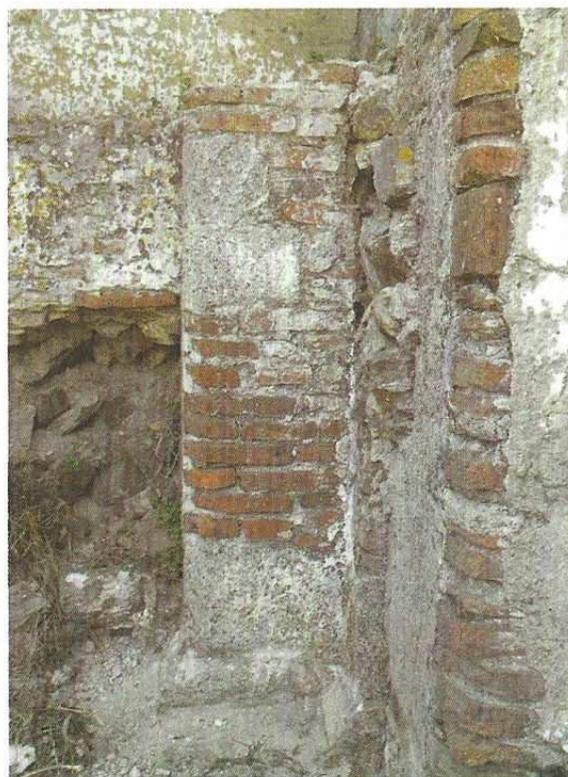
Pilar direito. Foi bastante destruído pela campanha de obras do século XVII, embora facilite um exame mais detalhado dos materiais de construção.
